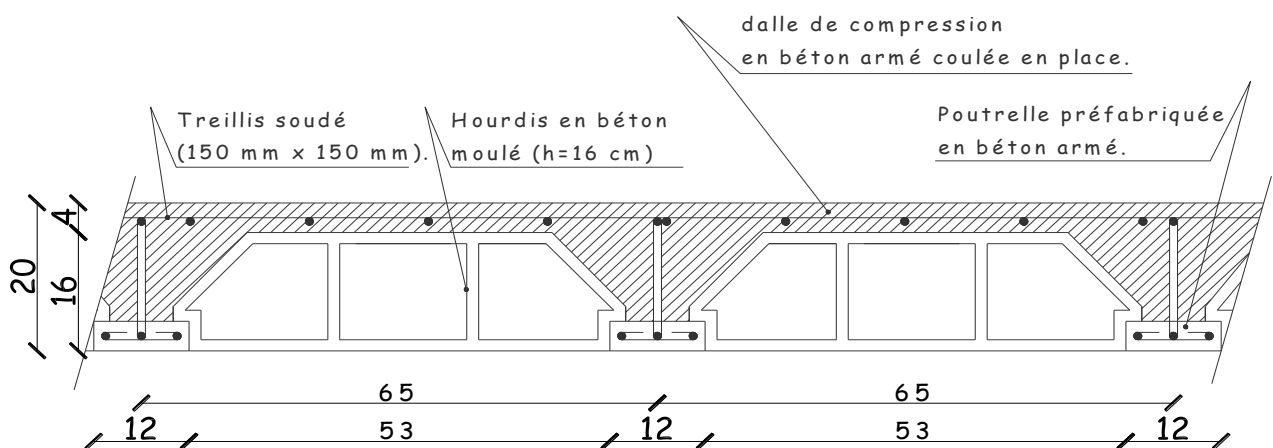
Plancher en béton armé avec poutrelles et hourdis (Plancher semi-préfabriqué)
